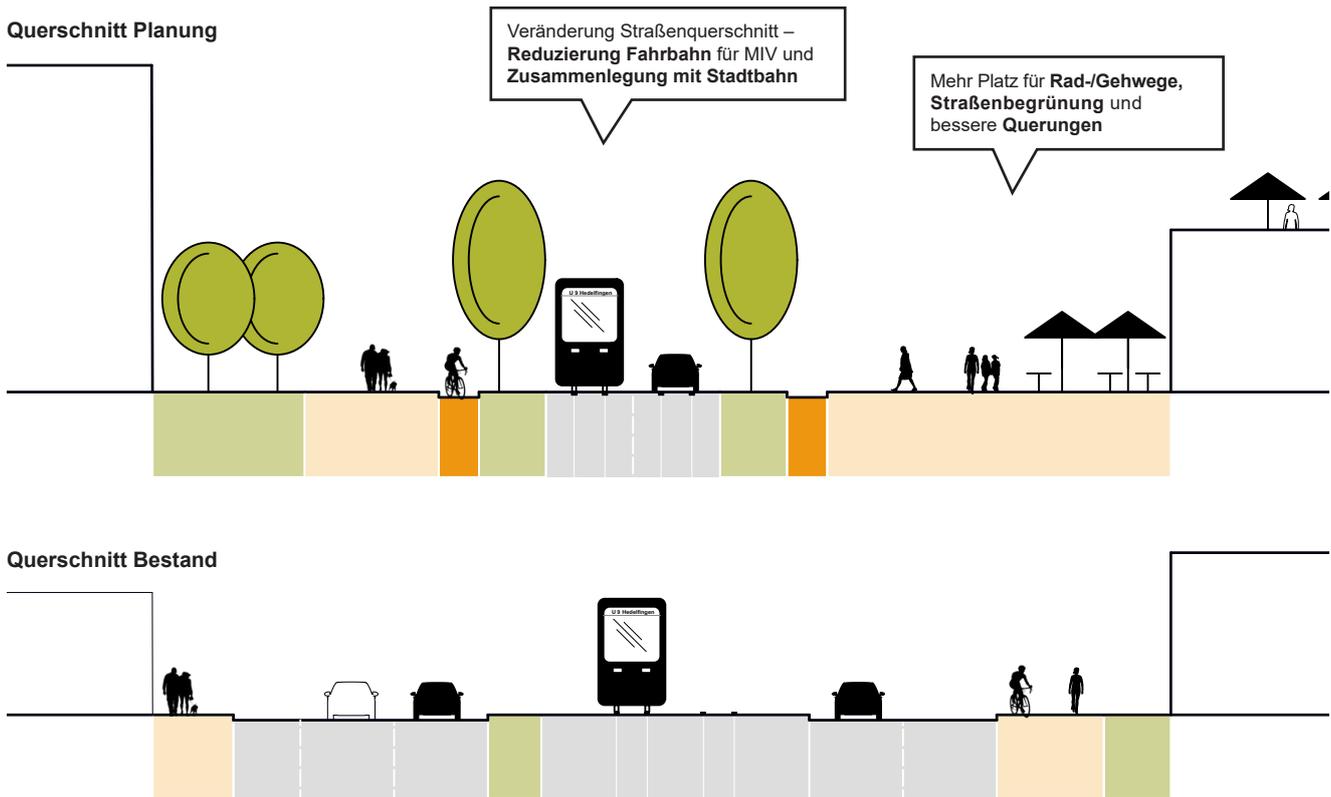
Veränderung Straßenquerschnitt (Eigene Darstellung)
